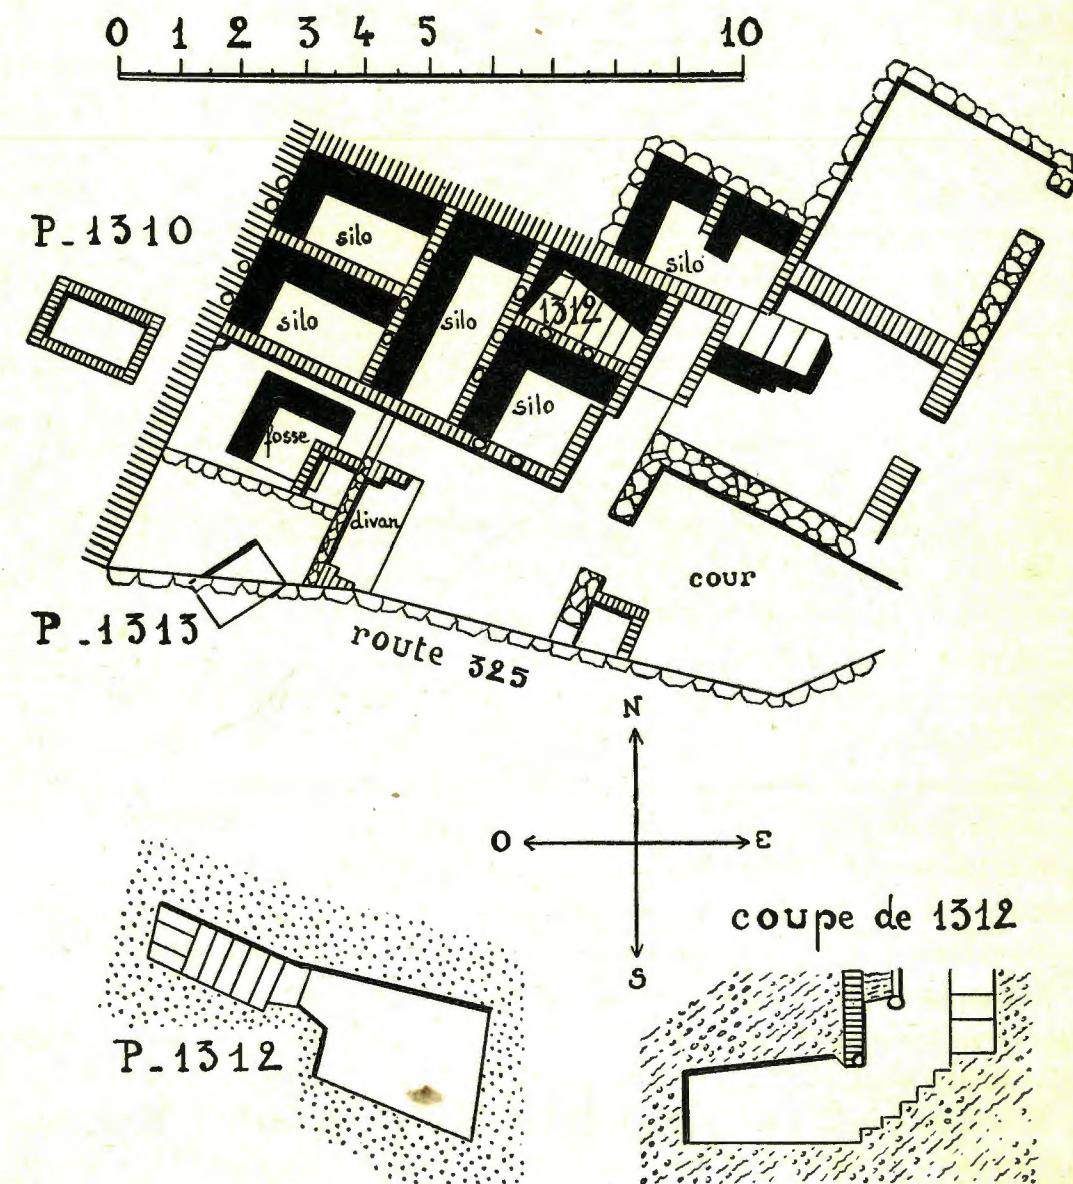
PLANS ET COUPE DE LA CAVE N° 1312.
